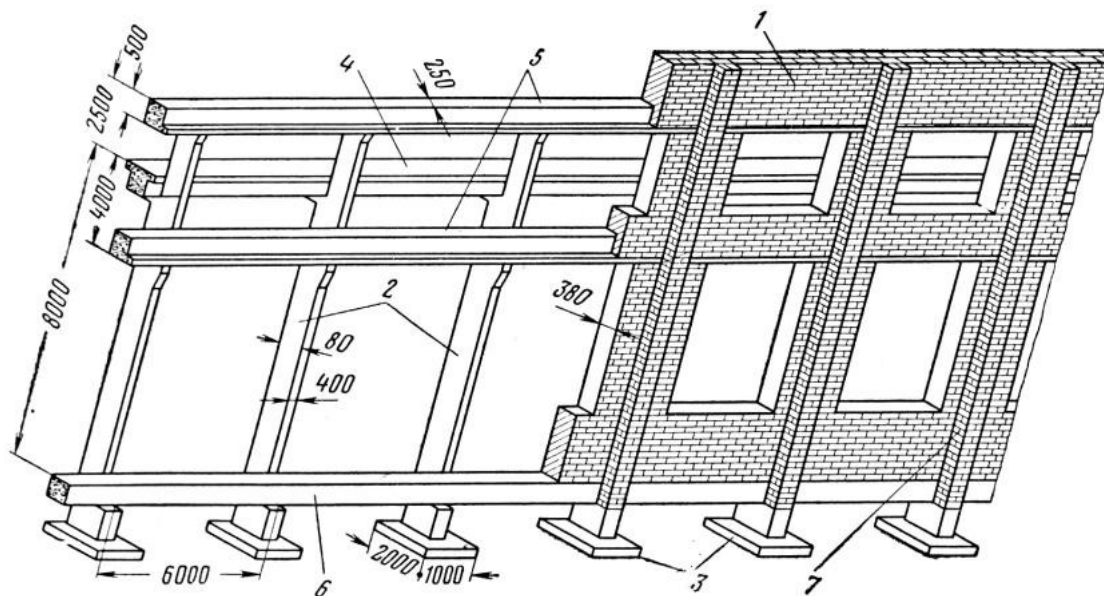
Конструкция каркасной стены здания с железобетонным каркасом:
